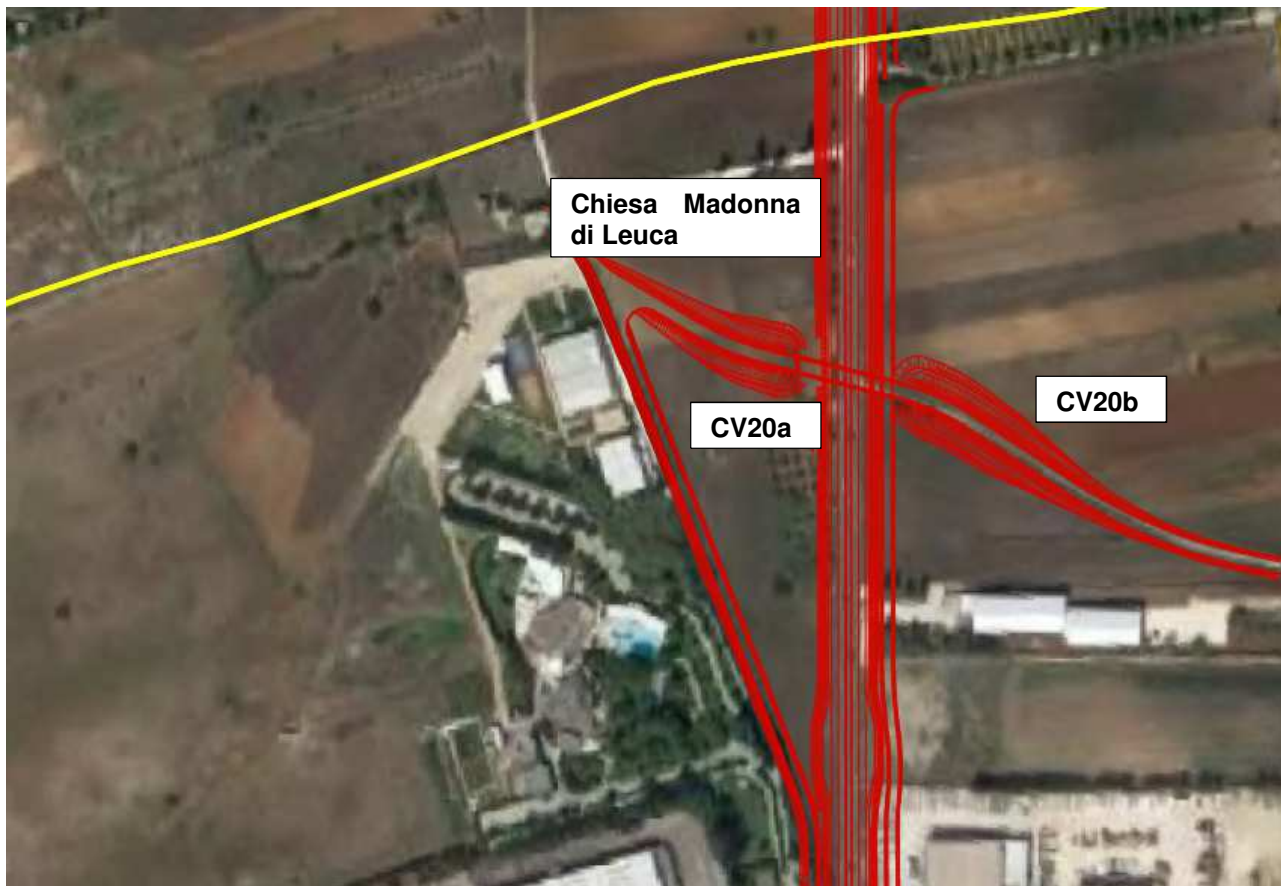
Ortofoto con sovrapposizione progetto 2022
